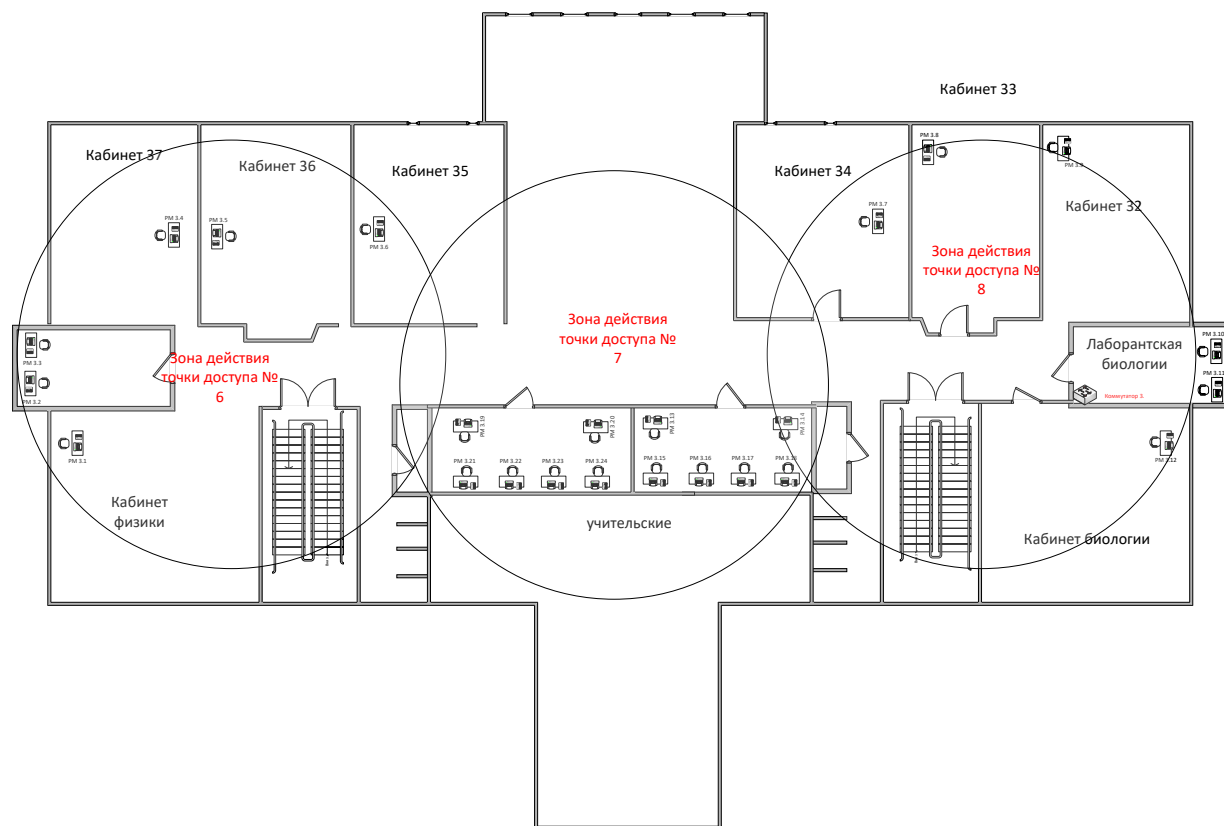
Схема размещения элементов сети на плане 3 этажа
